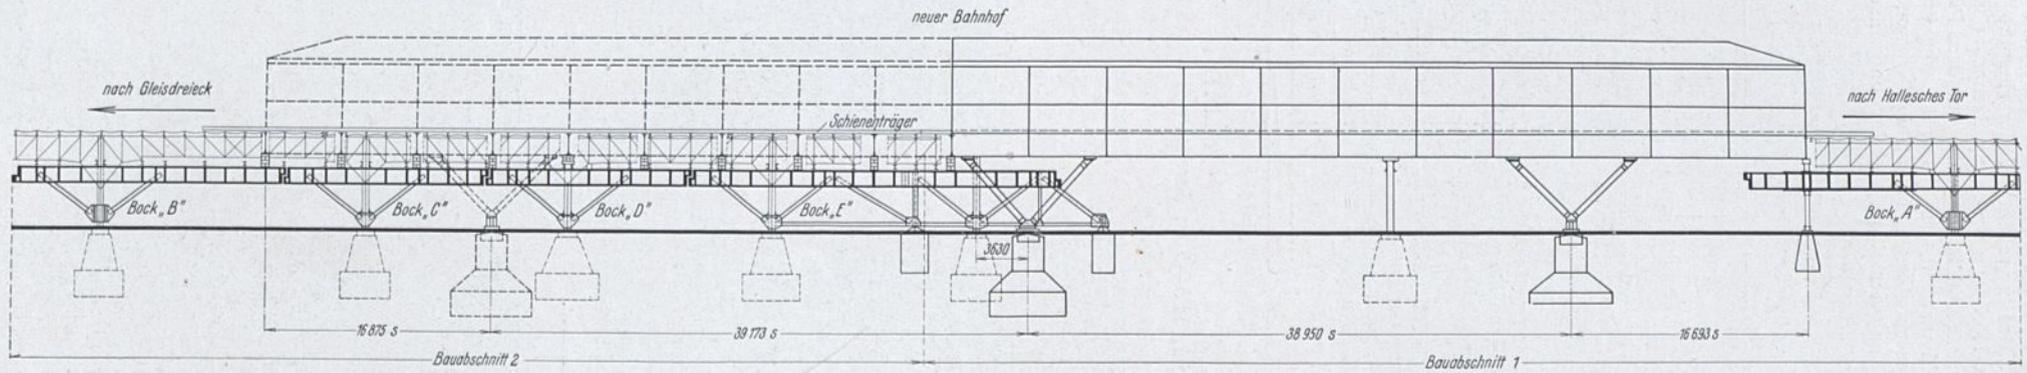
Zweiter Bauabschnitt. Die erste Hälfte des neuen Bahnhofs ist bereits in Betrieb.
